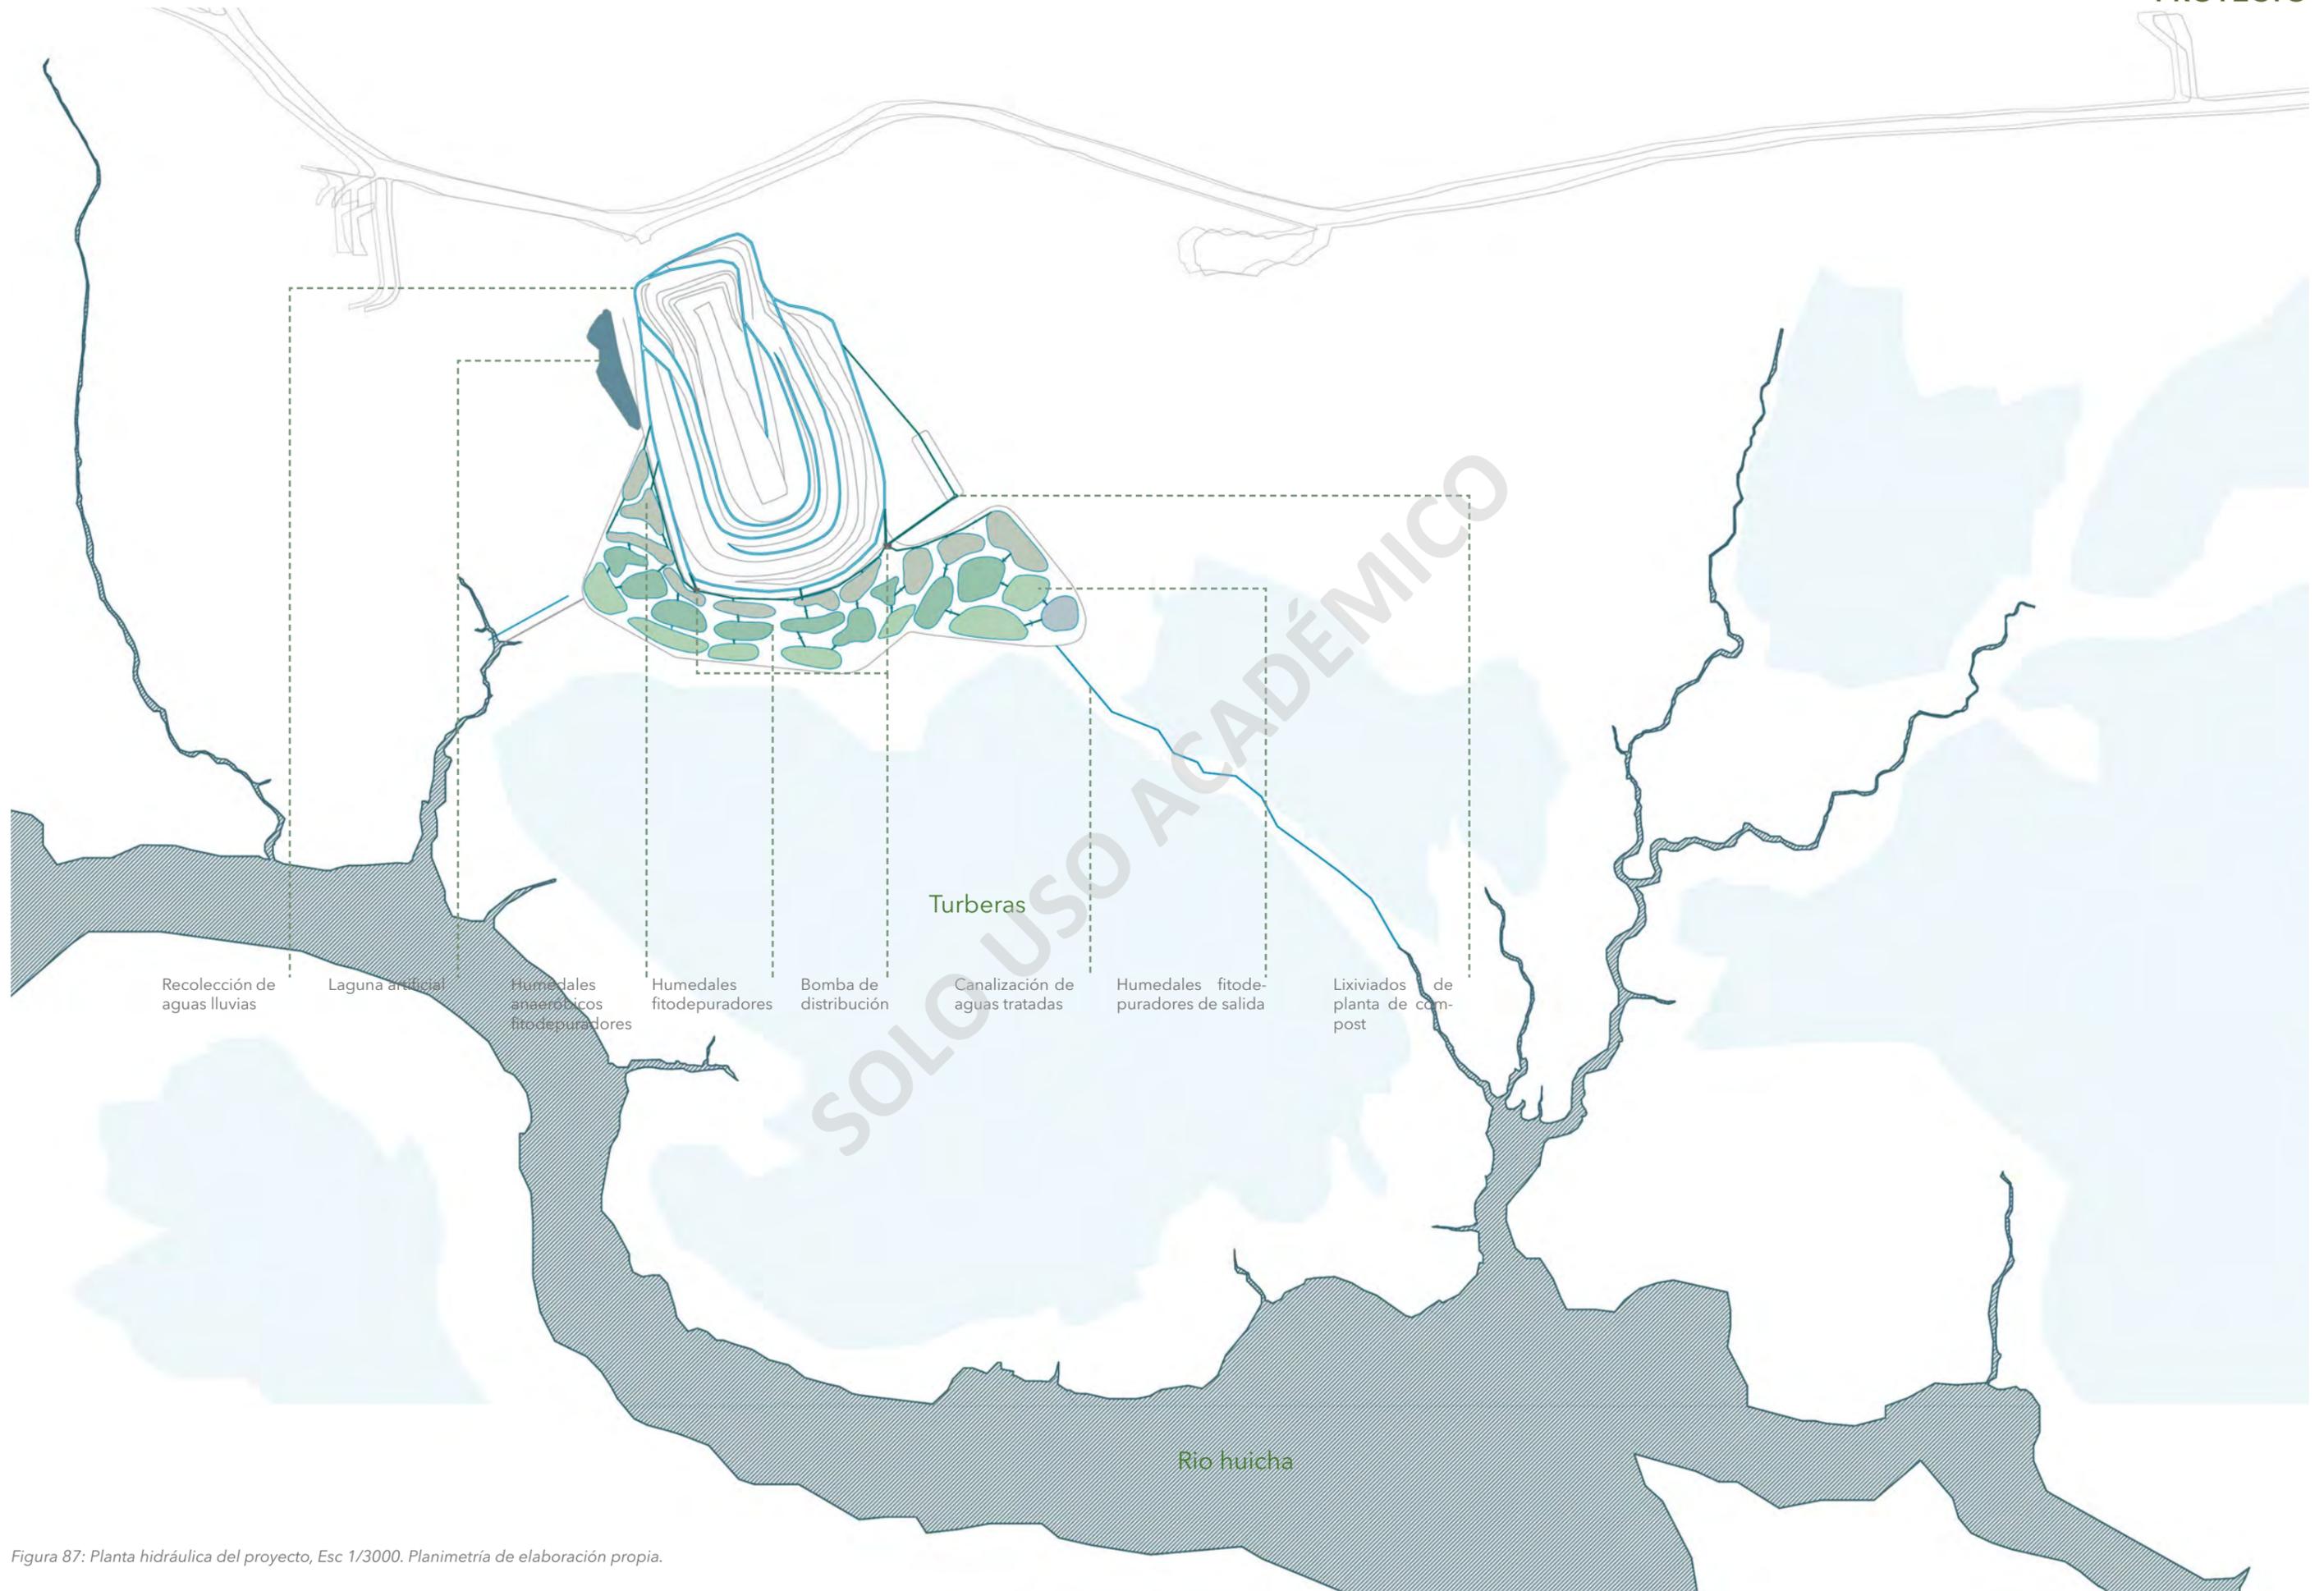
Planta hidráulica del proyecto, Esc 1/3000. Planimetría de elaboración propia.
